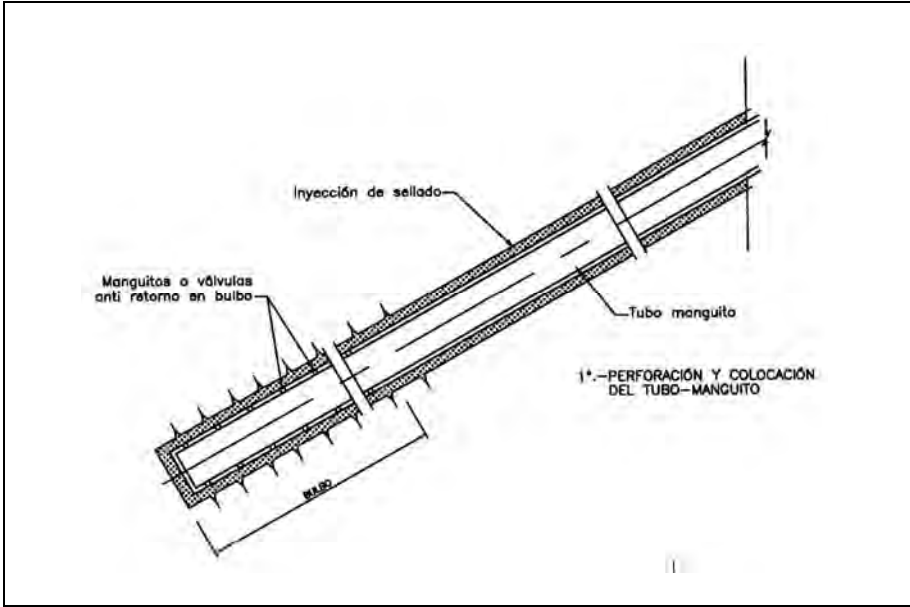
INYECCIÓN IRS, PRIMERA FASE
